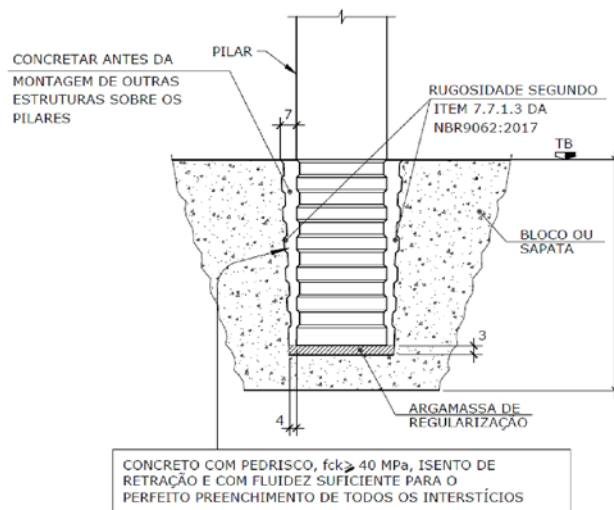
Detalhe do embutimento de pilar pré-fabricado em elemento de fundação
